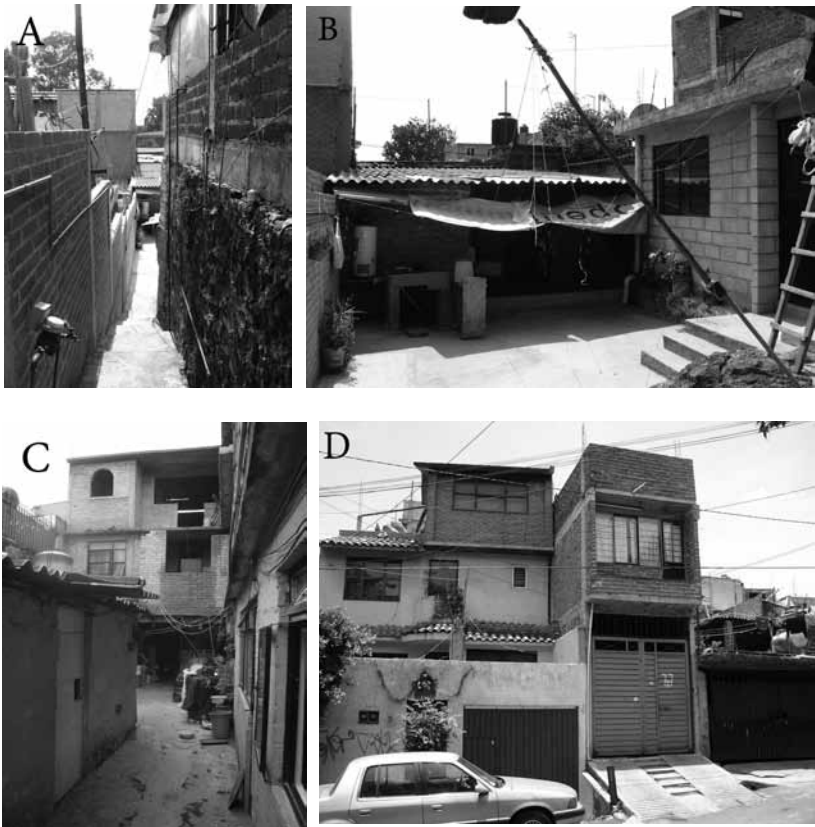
Construcción de otras casas en el lote y problemas del acceso a la casa de atrás.
